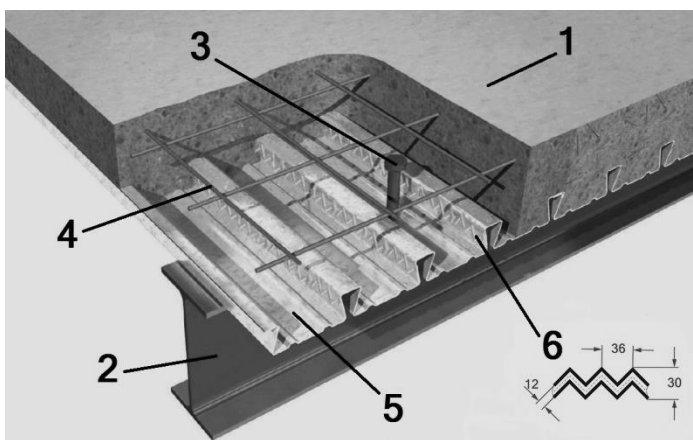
Монолитное железобетонное перекрытие с использованием профилированного настила:
